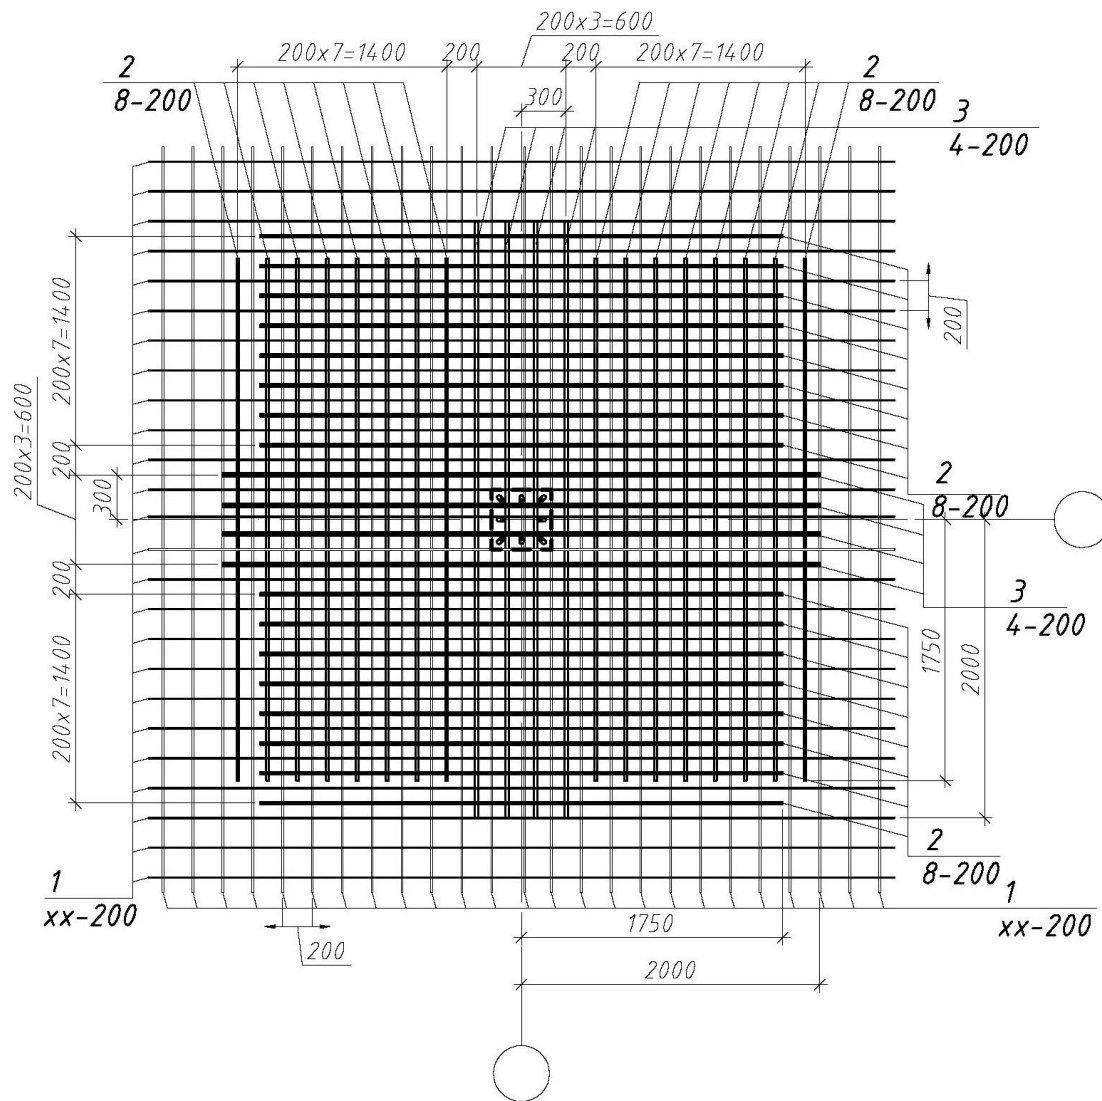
Узел верхнего армирования опорной зоны перекрытия (план)
